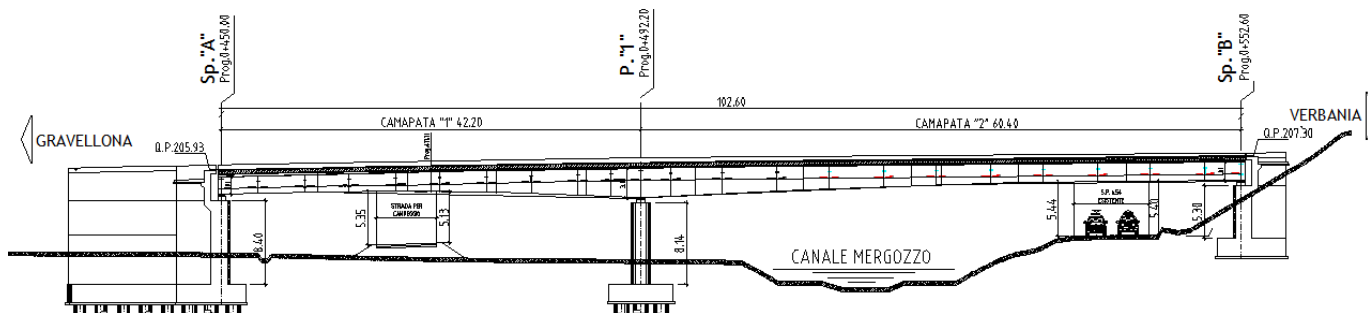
Progetto definitivo: Profilo longitudinale del viadotto
